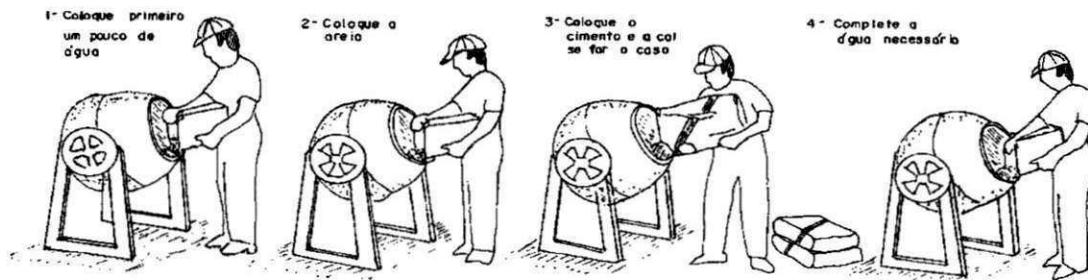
Preparação da argamassa de assentamento de alvenaria com betoneira
